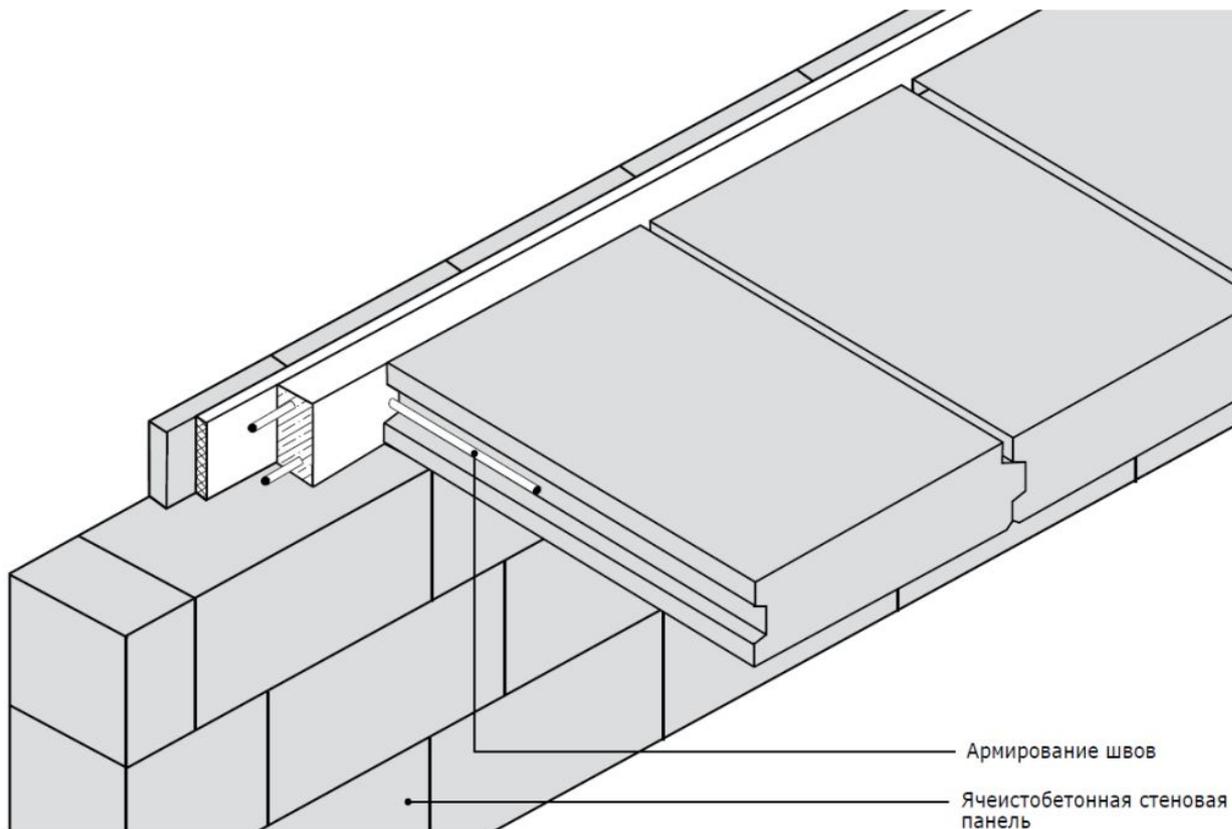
Зона сопряжения стена-перекрытие. Одностороннее опирание панелей перекрытия, обвязочный пояс в уровне перекрытия
